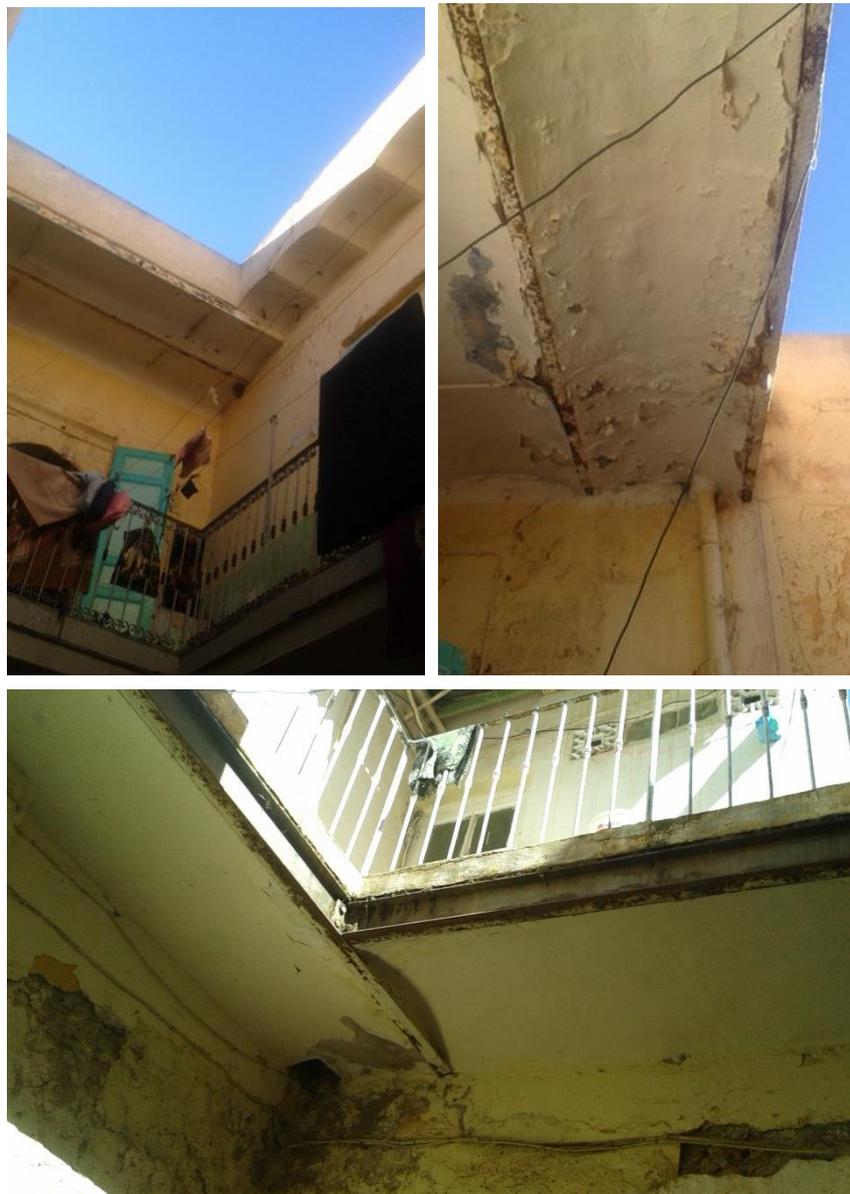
Plancher en voutains de brique supportés par des poutrelles métalliques de type IPN.
